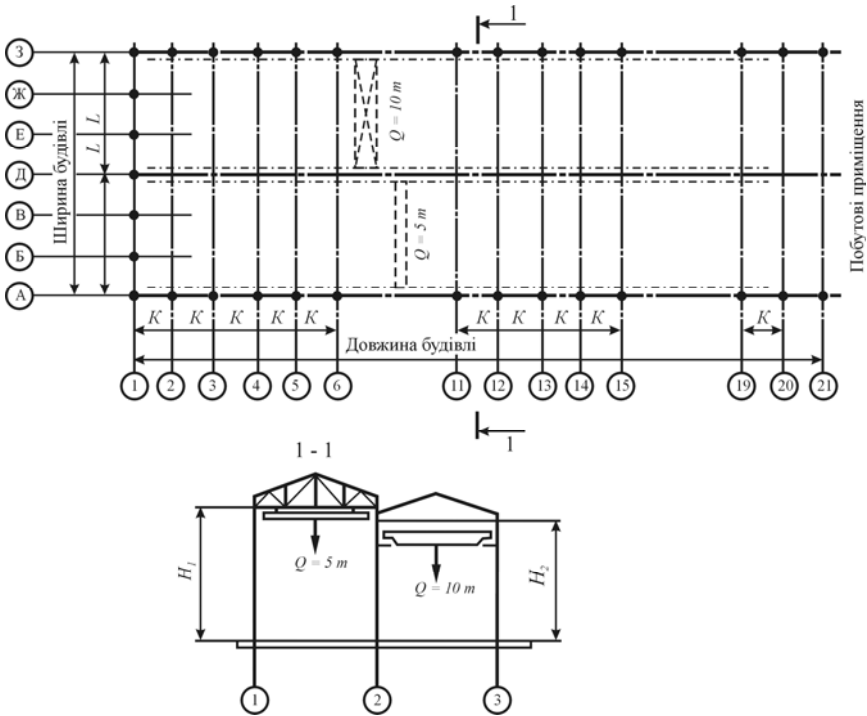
Схема одноповерхової промислової будівлі з двома прогонами
